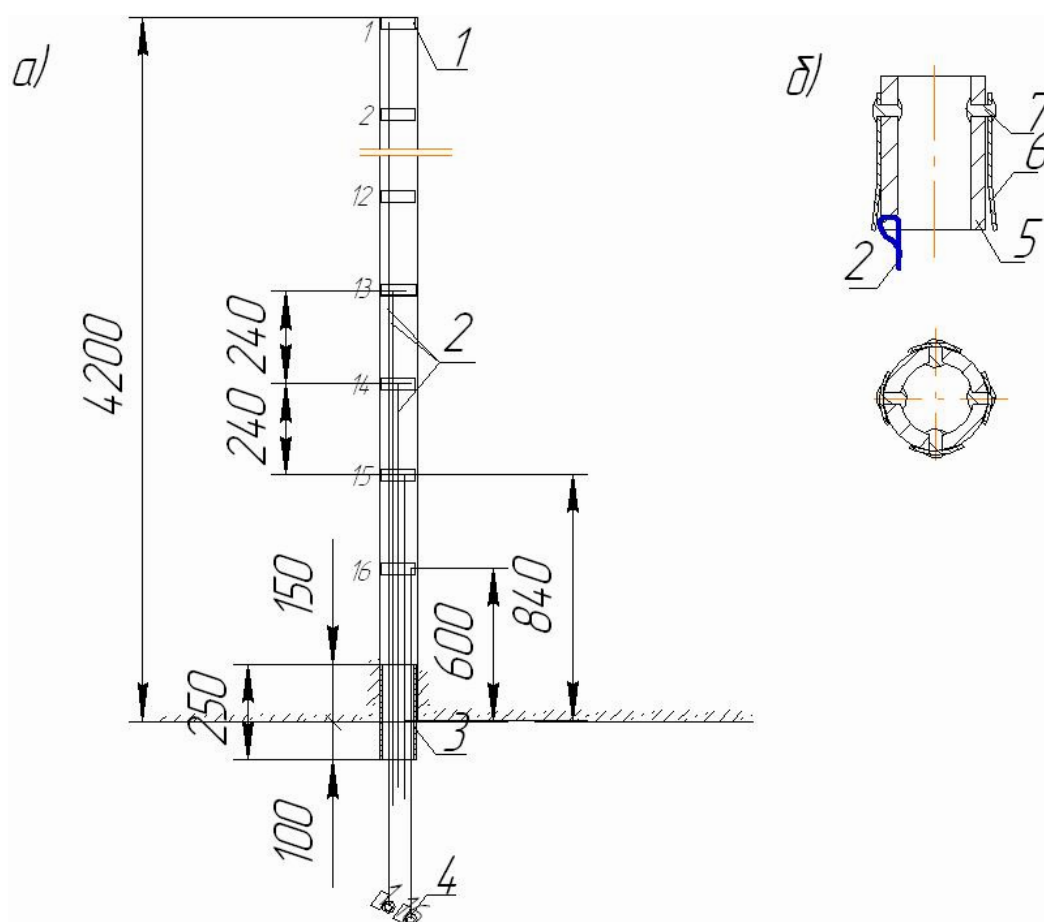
Схема замерной станции (*а*) и конструкция глубинного репера (*б*): 1 — глубинный репер; 2 — тяги глубинных реперов; 3 — кондуктор; 4 — замерное кольцо; 5 — отрезок стальной трубы; 6 — стальная полоса; 7 — заклепка
